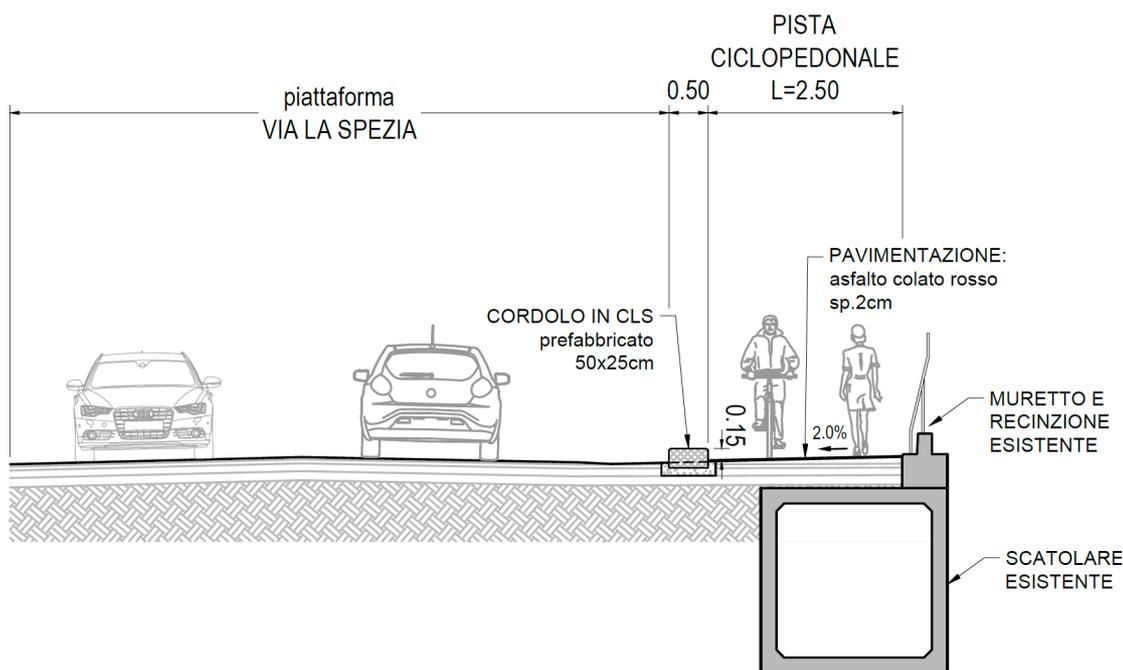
Sezione tipo pista ciclopedonale con cordolo spartitraffico
